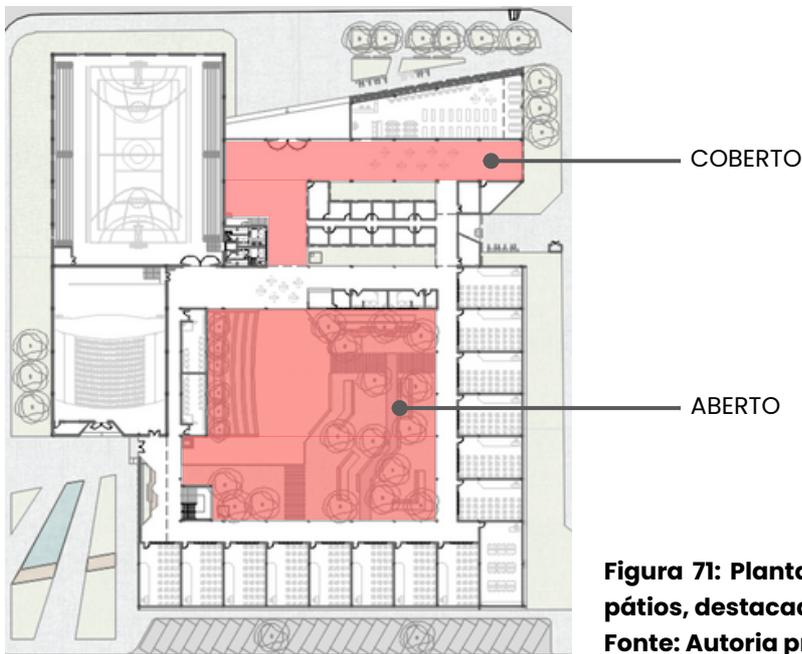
Planta baixa do térreo com localização das pátios, destacadas em vermelho.
